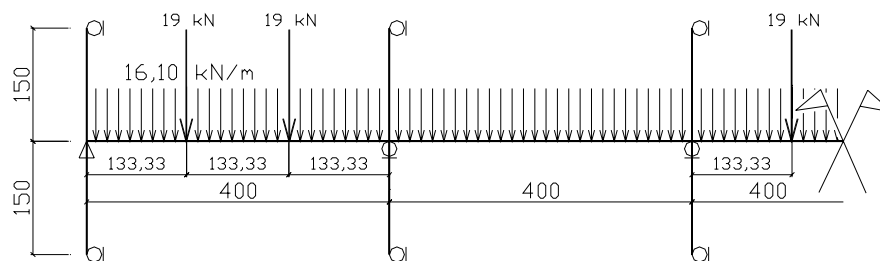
Esquema estrutural e de carregamento, Caso 5 (dimensões em cm)
